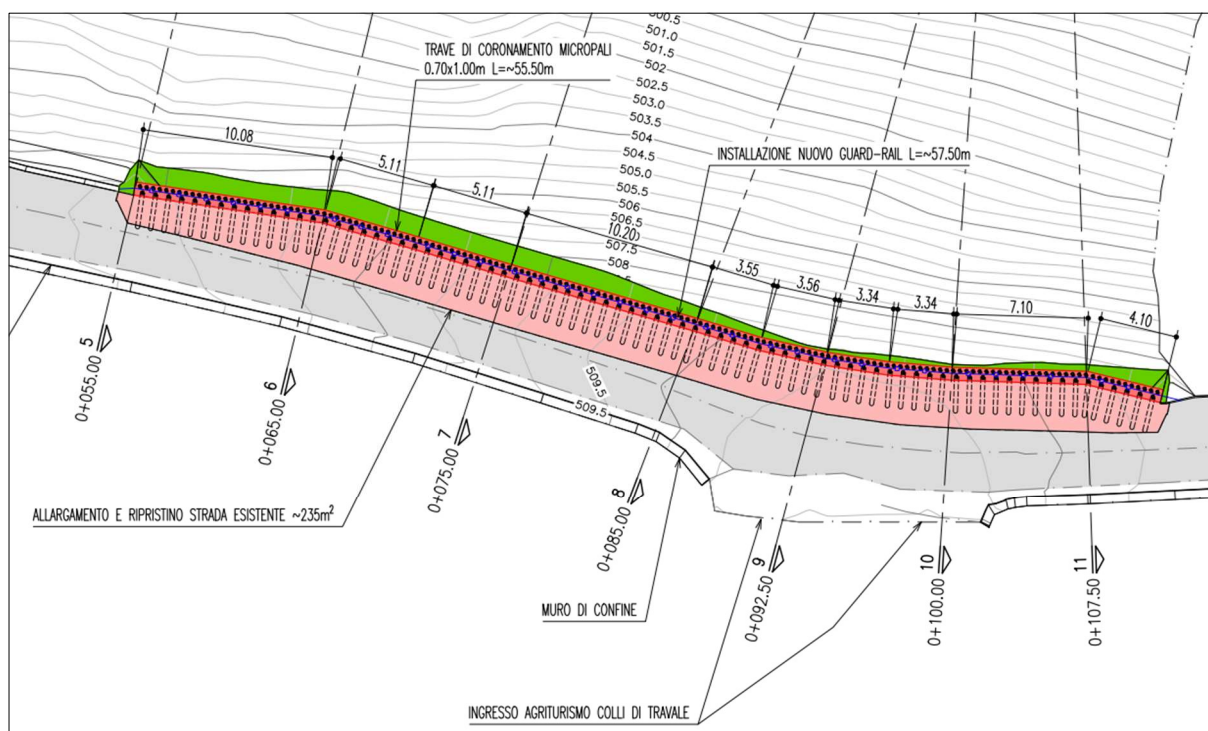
Planimetria dello stato di progetto con individuazione dell'area di intervento.
